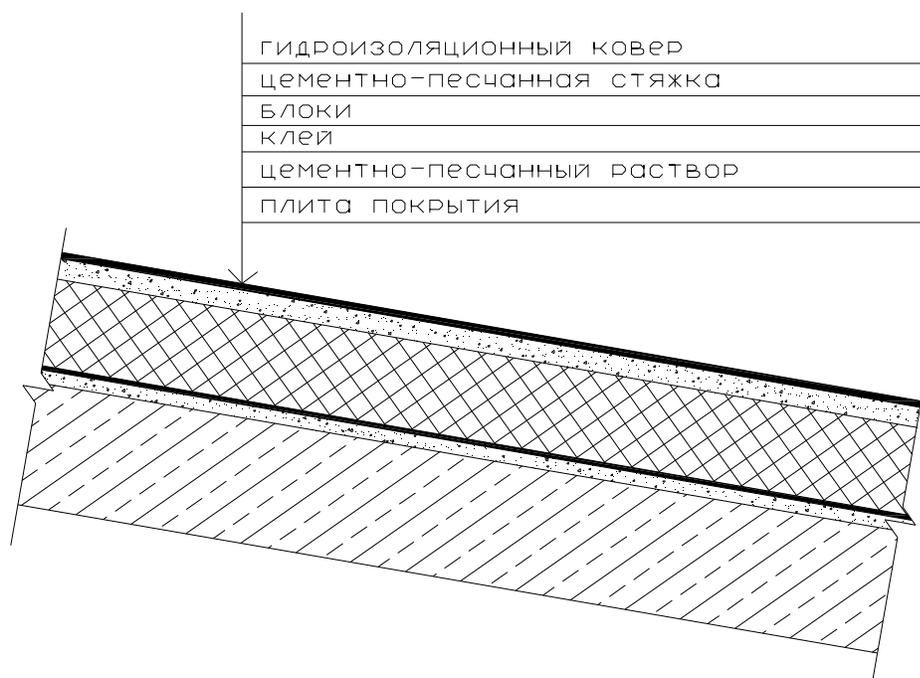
Тепловая изоляция совмещенной плоской кровли из блоков
